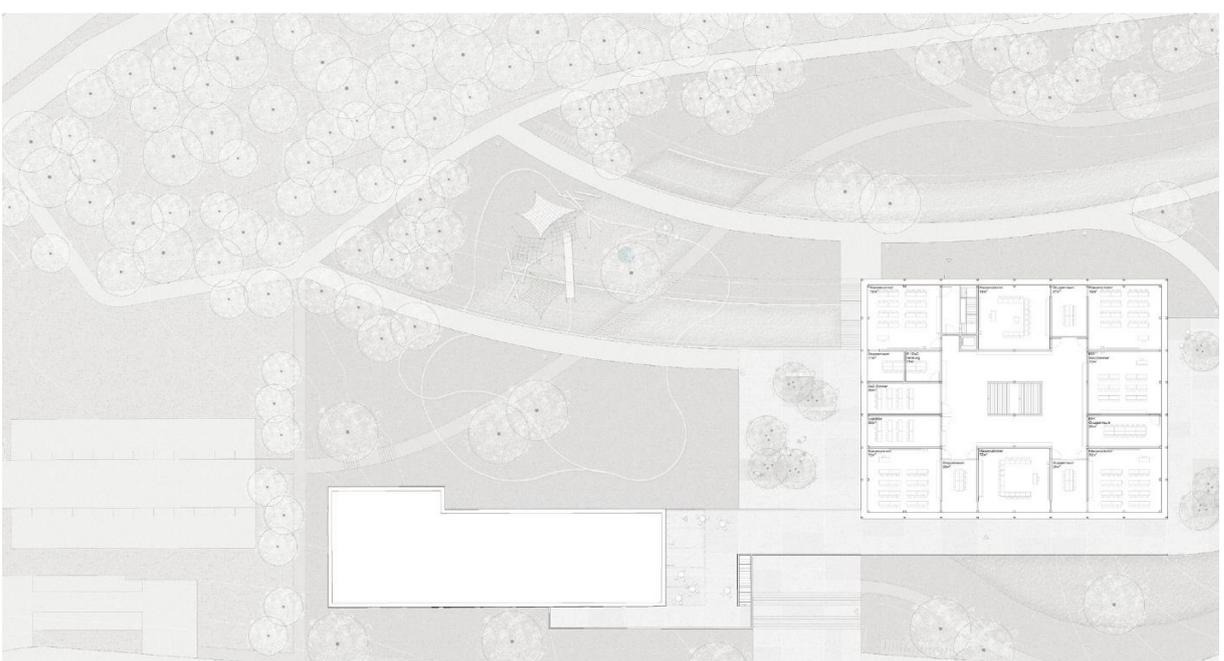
Grundriss 1. Obergeschoss Primarstufe
